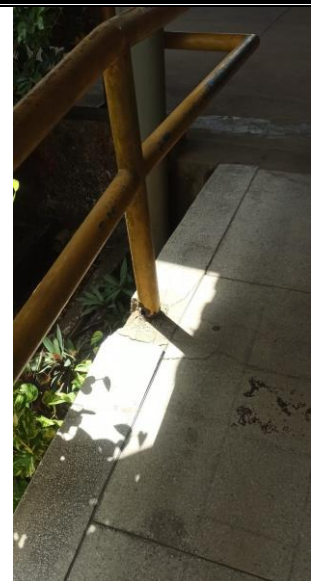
REPARO EM RAMPA E CORRIMÃO
